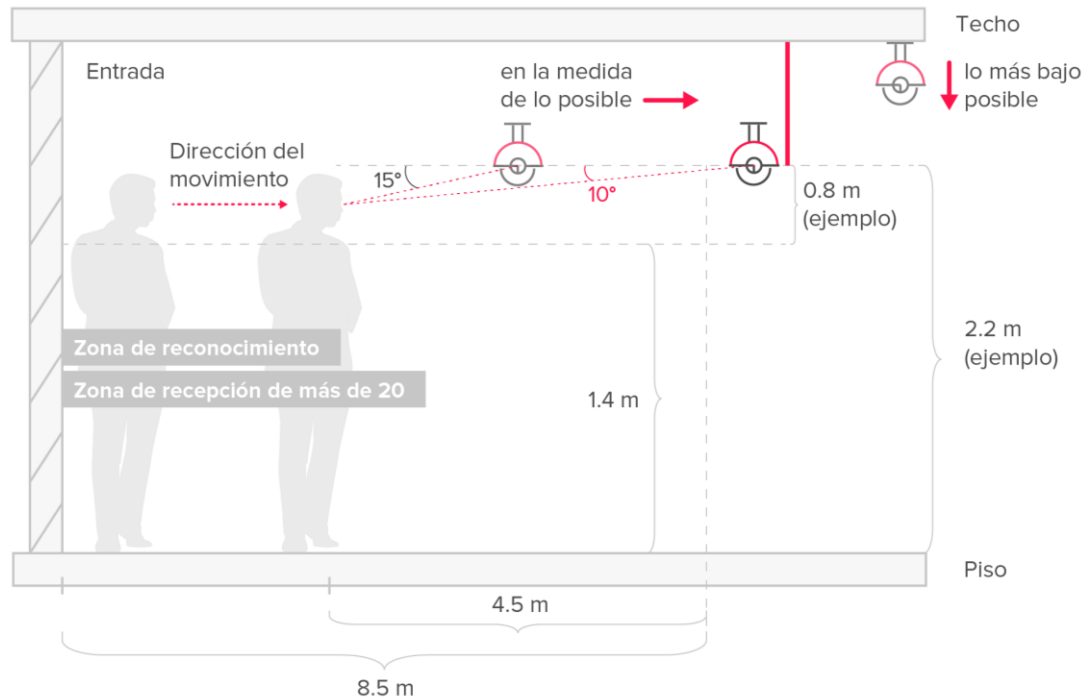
Recomendaciones sobre la instalación de las cámaras
